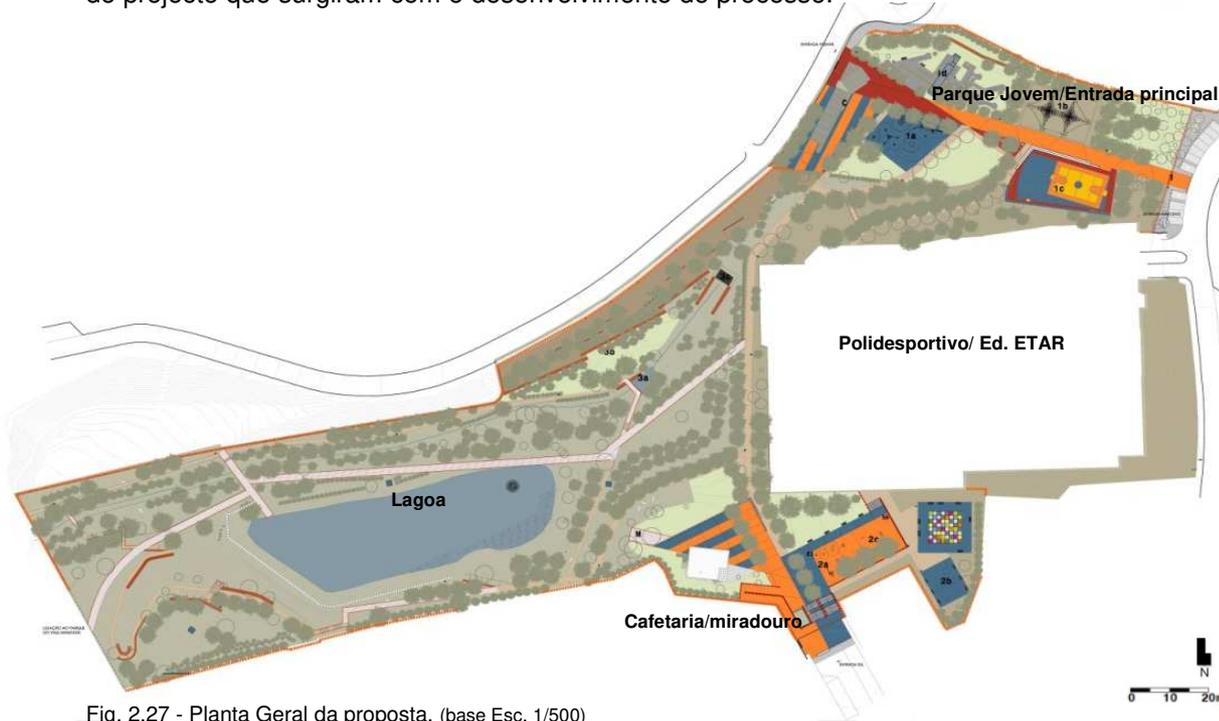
Planta Geral da proposta. (base Esc. 1/500)
